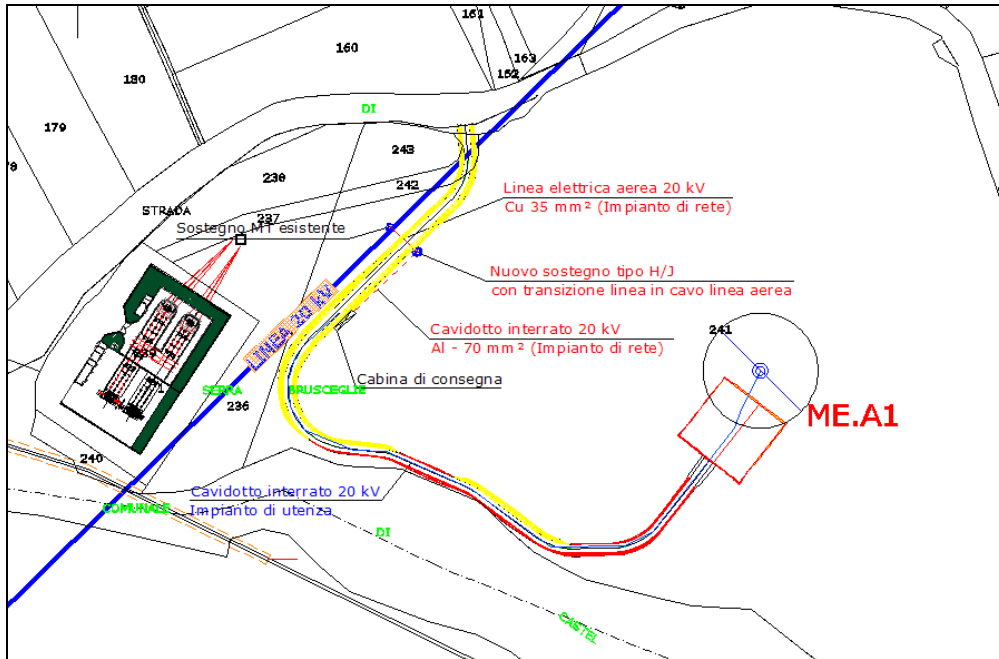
Layout di progetto su planimetria catastale (fg31-Comune di Ripacandida).
